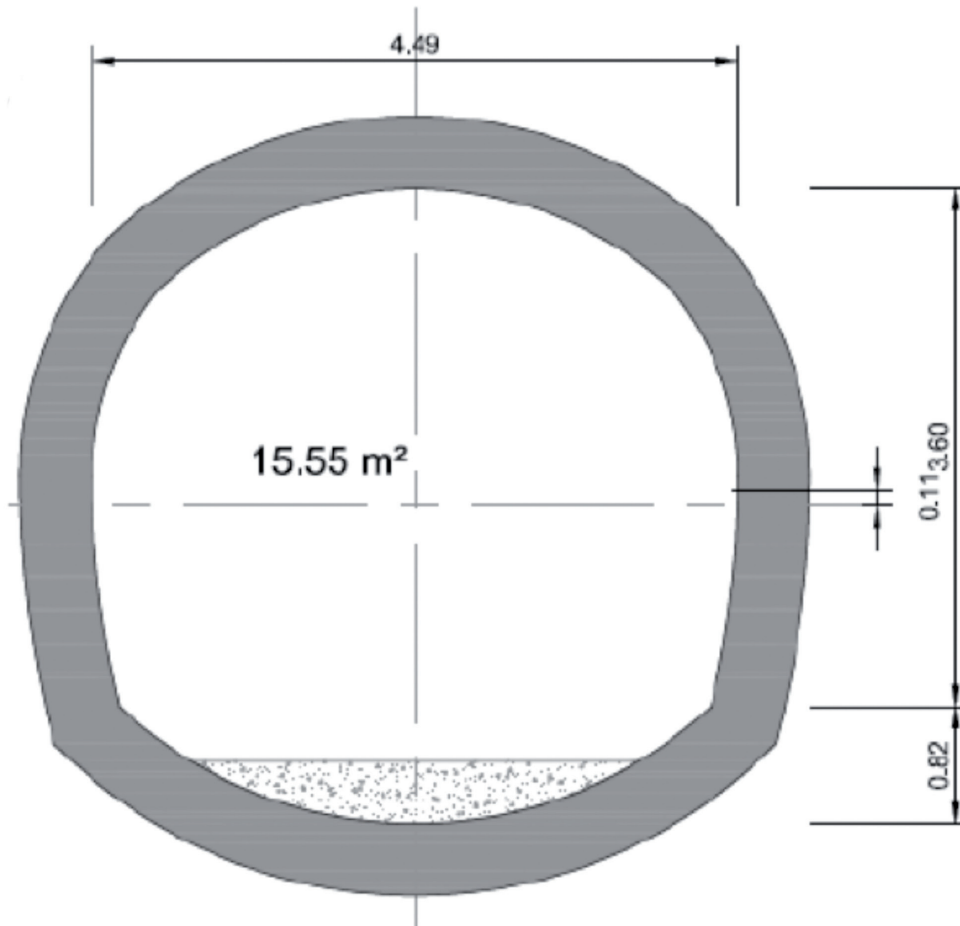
Coupe fonctionnelle du rameau ventilation L17 (bitube)
